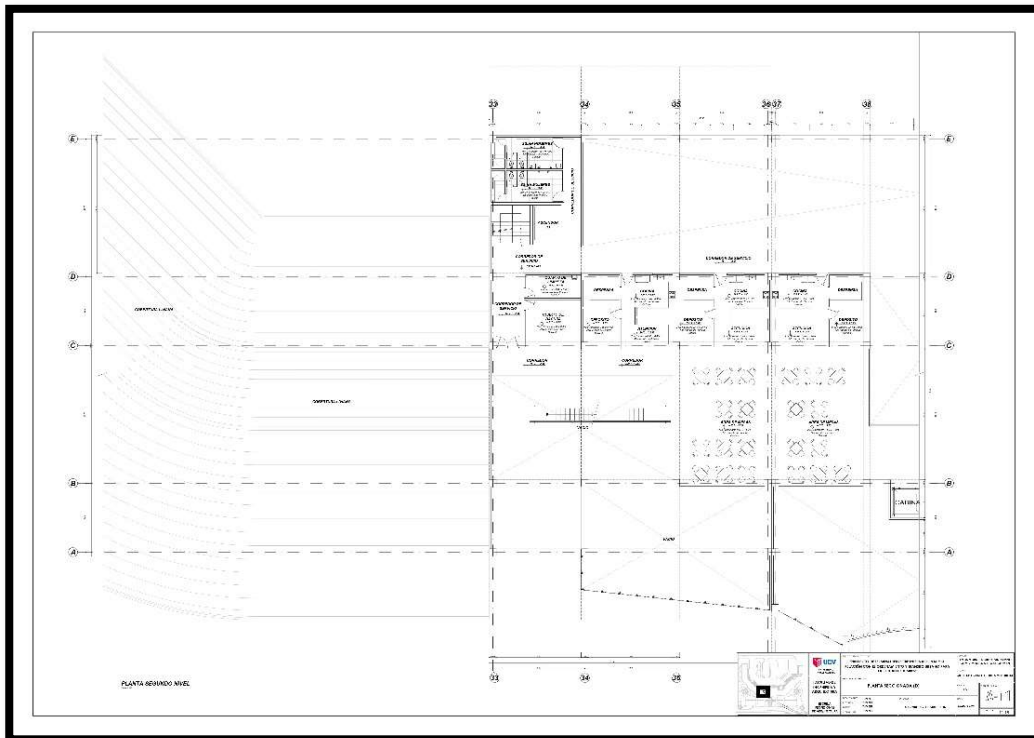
Plano Planta sector (D) Segundo Nivel Fuente: Elaboración Propia.
